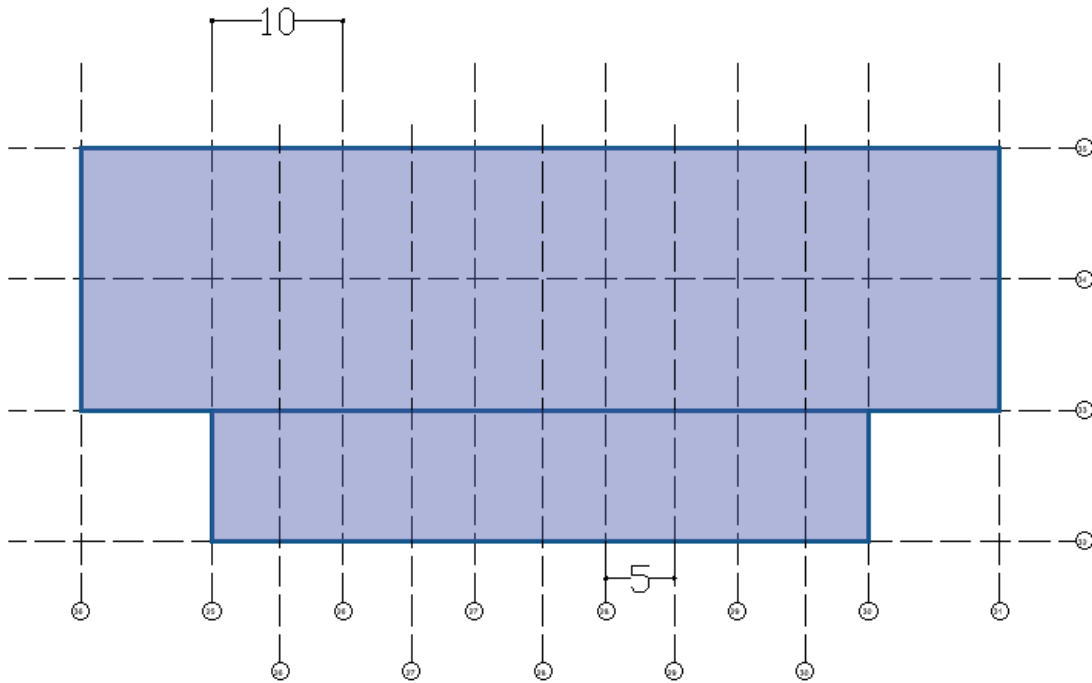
Modulación arquitectónica de la Terminal aérea. Fuente: Elaboración propia
